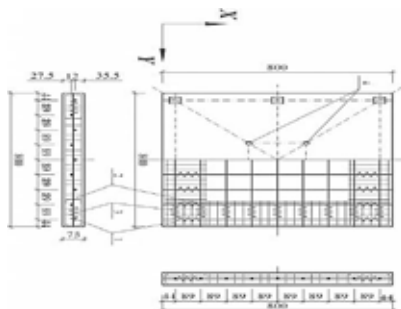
Армування випробувальних плит-зразків: 1 – арматурні стержні; 2 – “II” - подібні арматурні сітки; 3 – спіралі; 4 – круглі марки.
